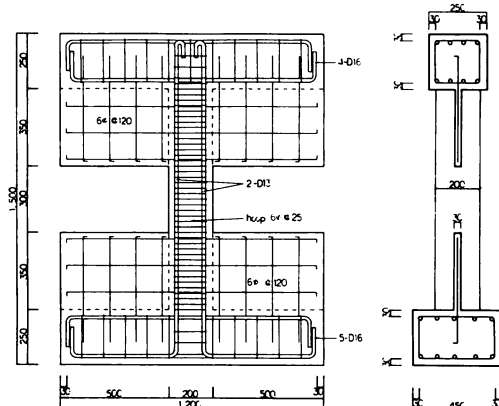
(c) 試験体 CSS03 の配筋図 (寸法単位mm)
